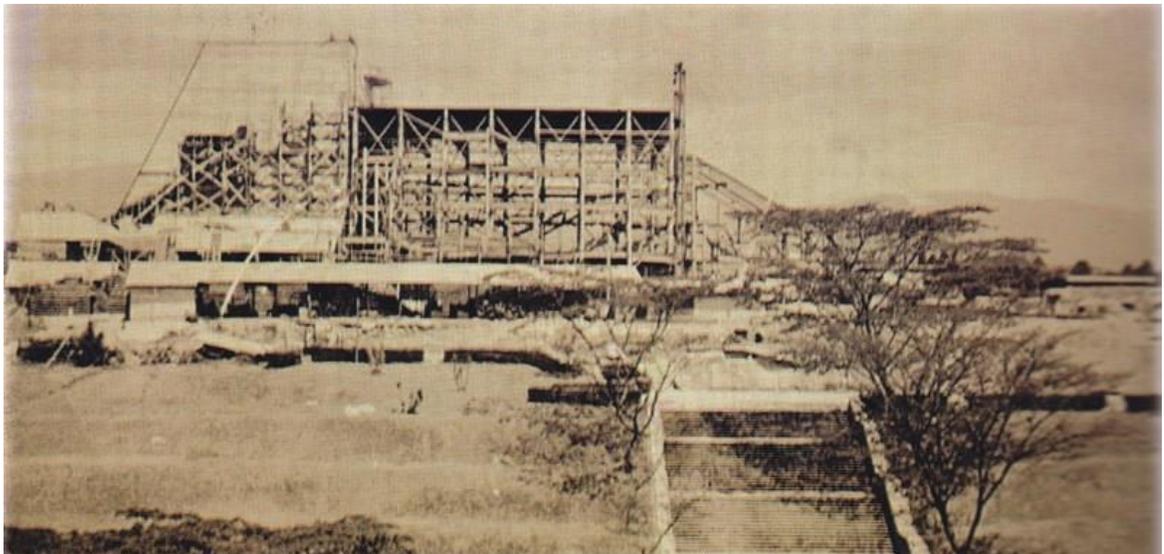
Construcción de la Fase 1 de la Fachada Este del CCMAA
